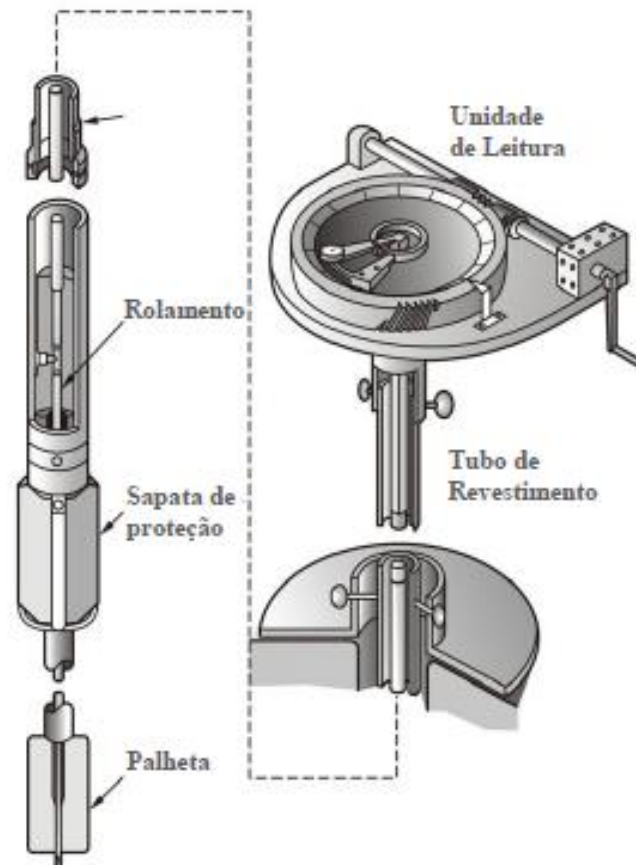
Equipamento para o ensaio de palheta in situ (ORTIGÃO E COLLET, 1968).
